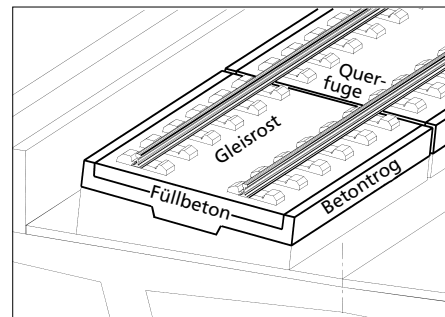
Feste Fahrbahn System Rheda auf langen Brücken: die auf der Höckerplatte liegende Oberbauplatte besteht aus Betontrug und in Füllbeton einbetoniertem Gleisrost
